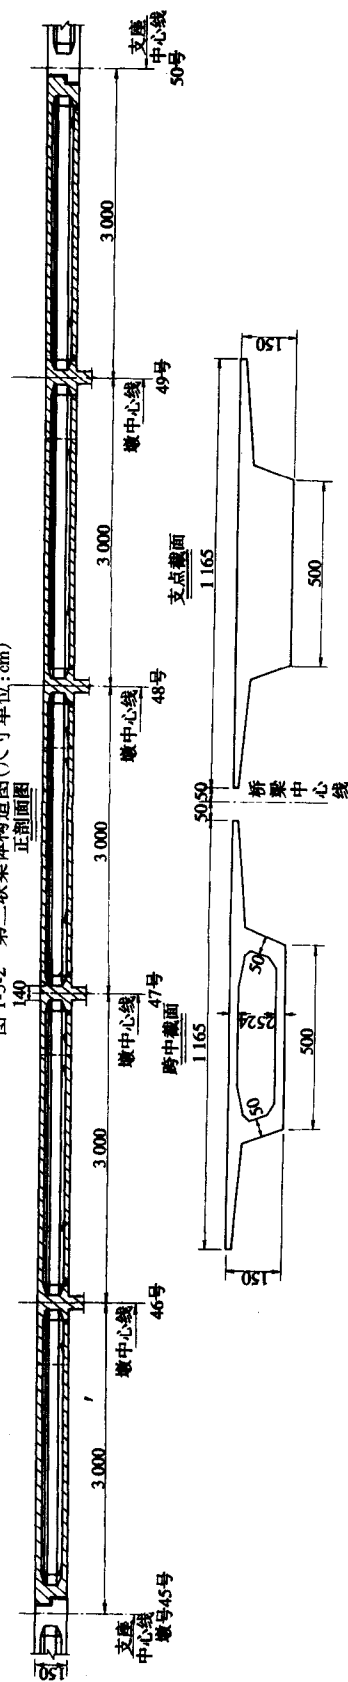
第三联梁体构造图(尺寸单位:cm)
